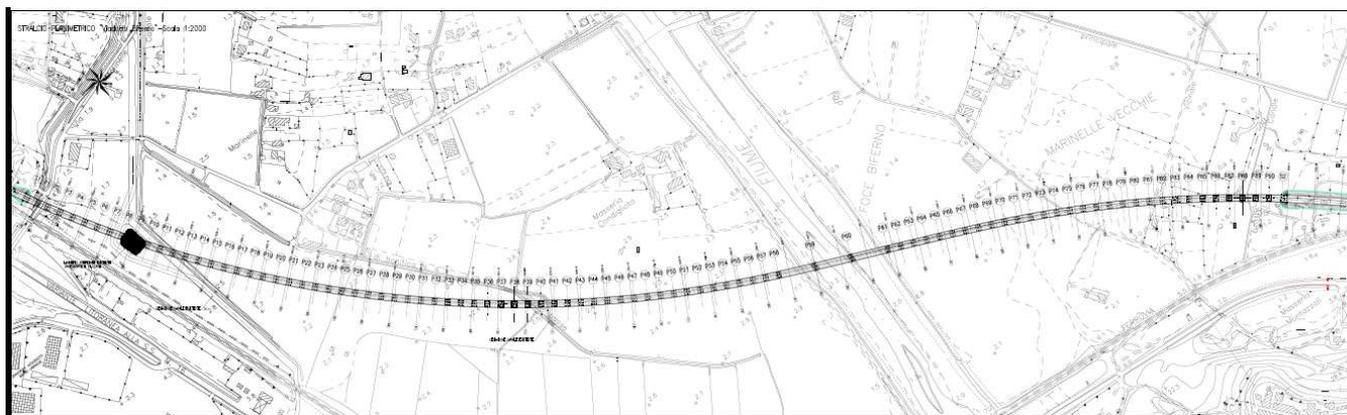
Viadotto Biferno: stralcio planimetrico
